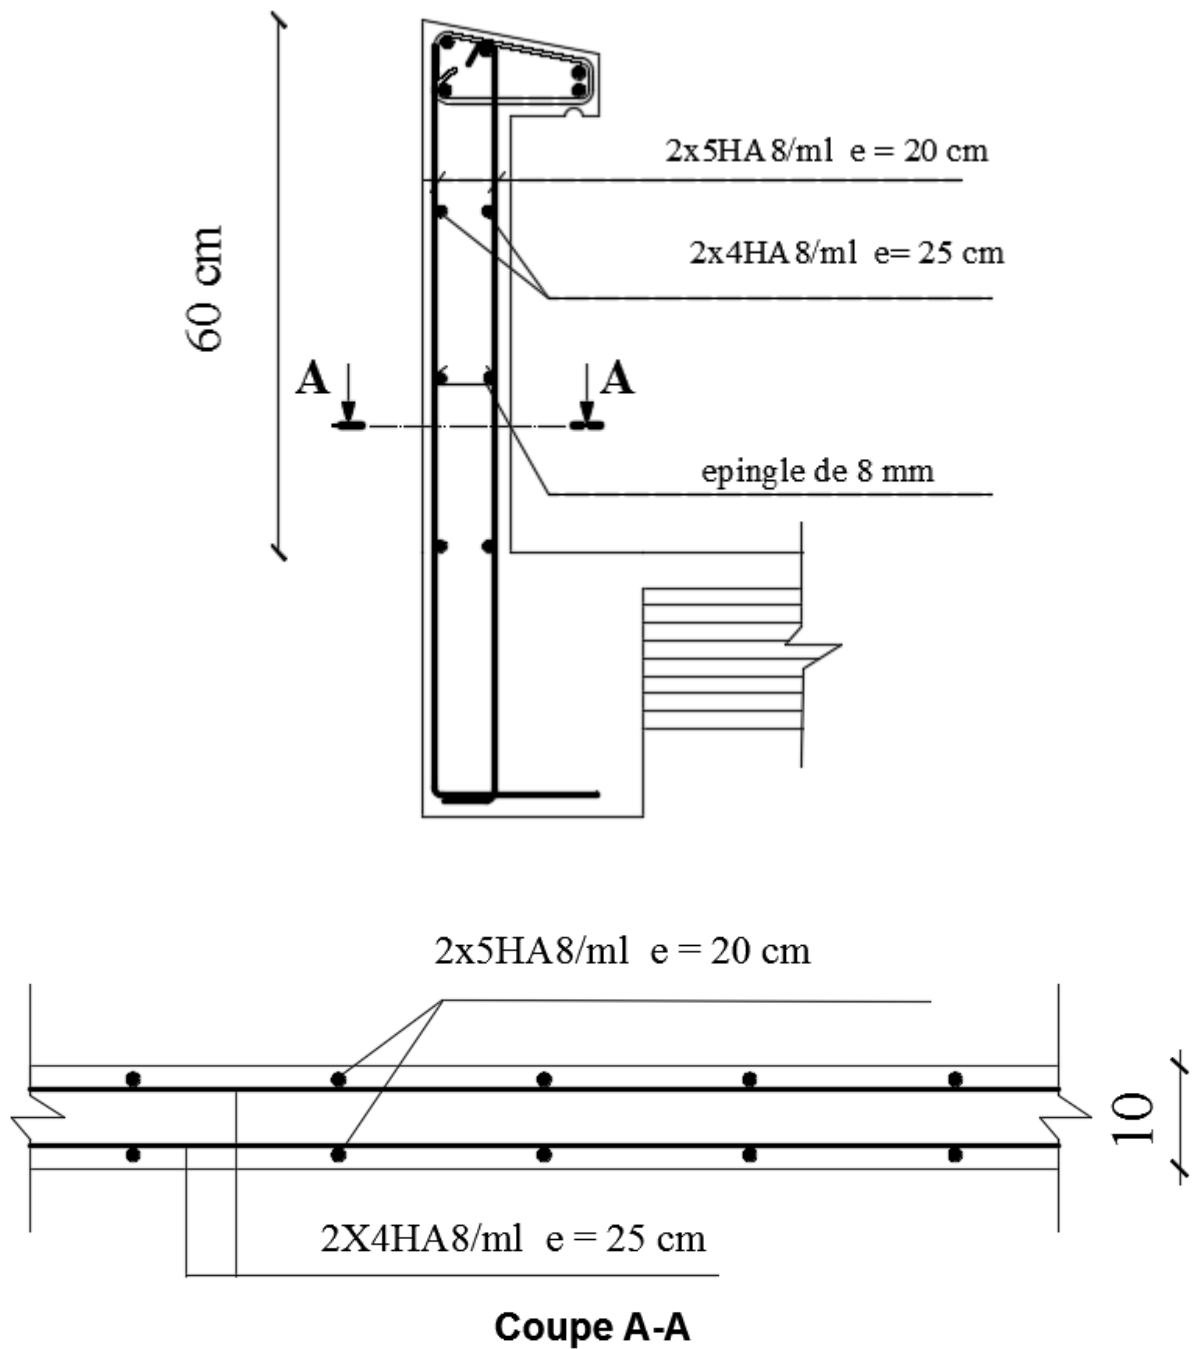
schéma de Ferrailage de l'acrotère.
